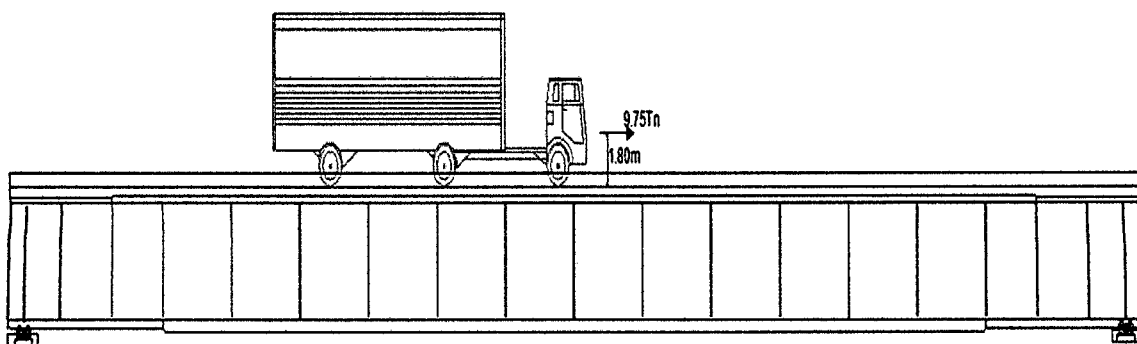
Acción de la Fuerza de Frenado – Camión de Diseño HL-93 - Para el Primer y Segundo Tramo.
